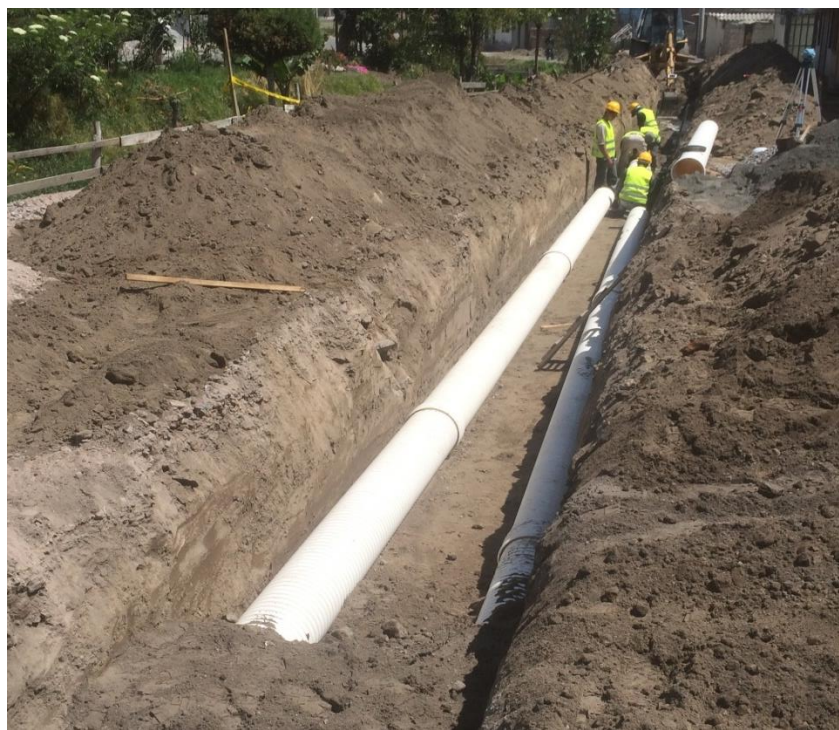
3: Regado de hormigón para Alcantarillado
